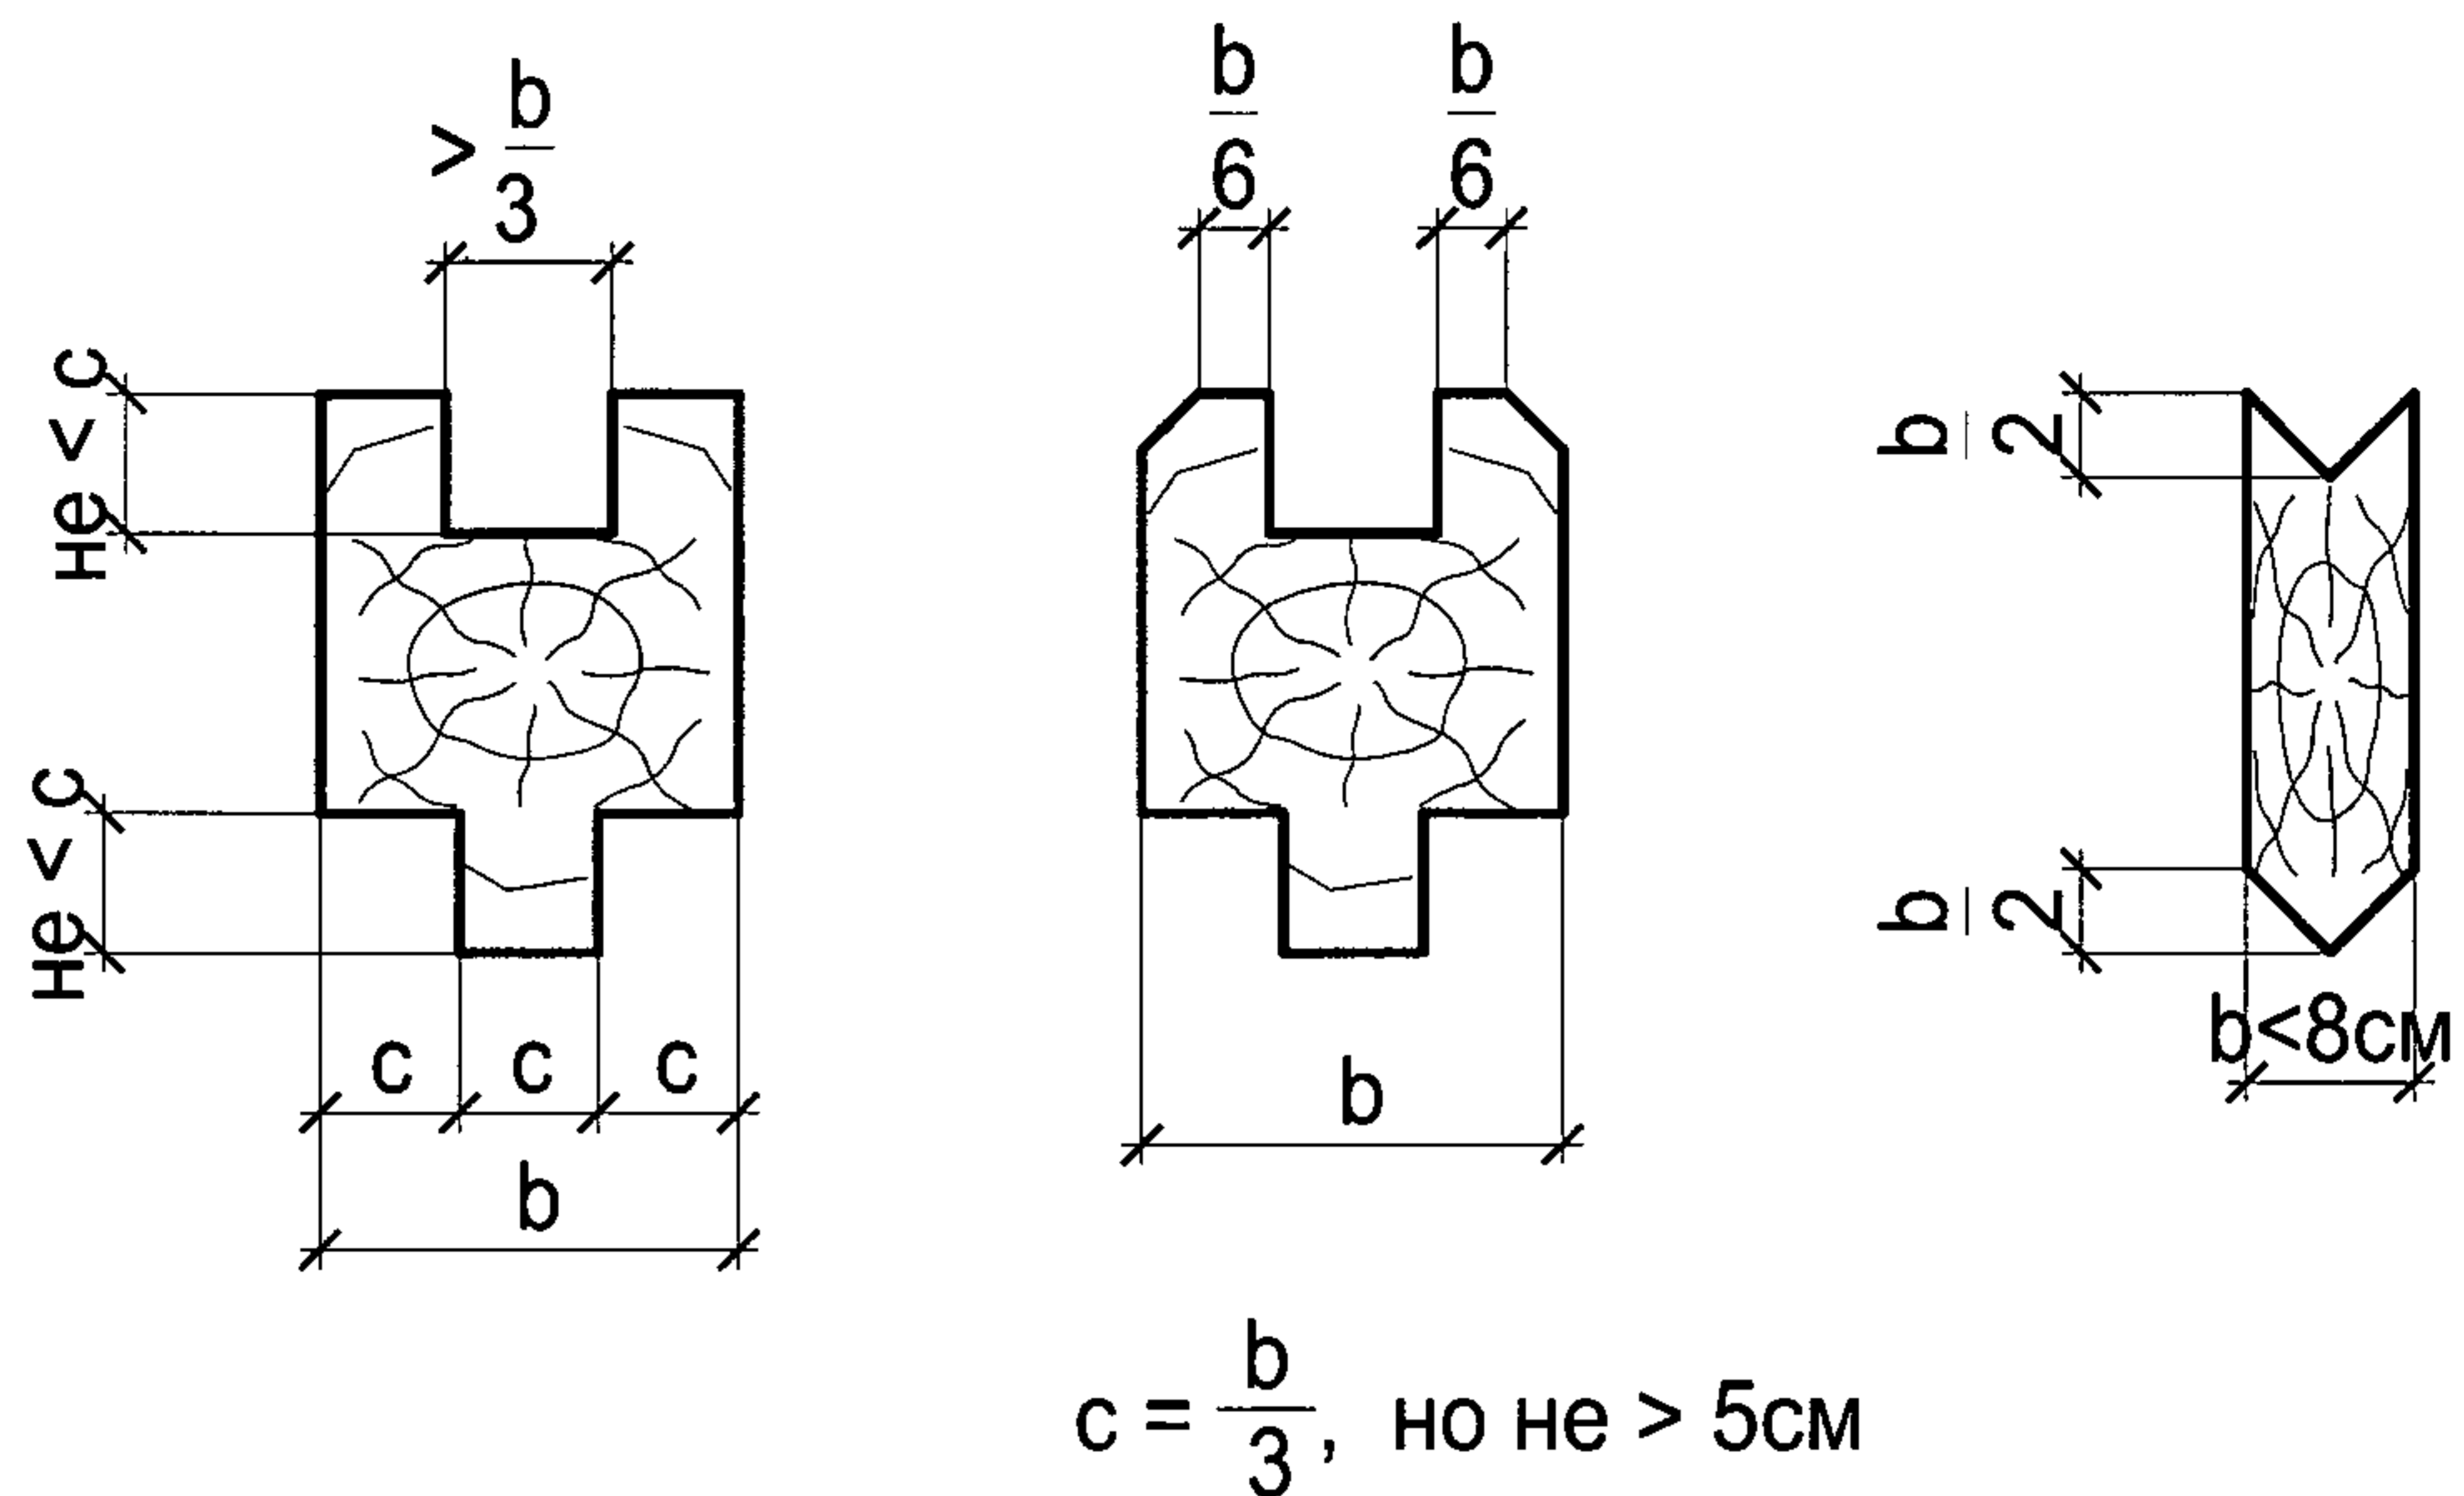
Поперечное сечение деревянного шпунта
